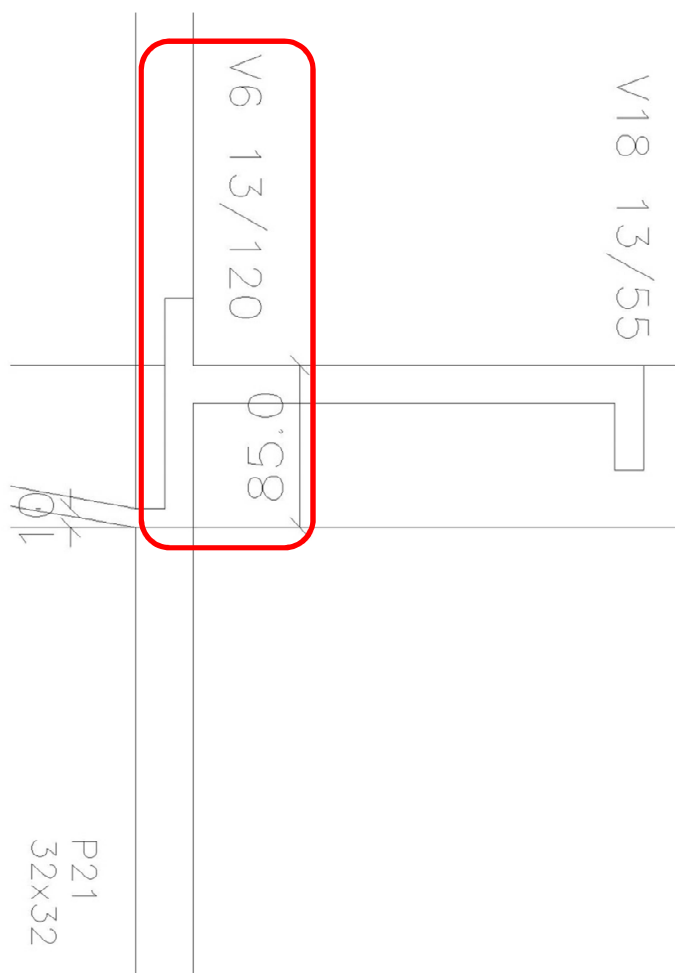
Corte BB do projeto estrutural, em destaque a viga V6.
